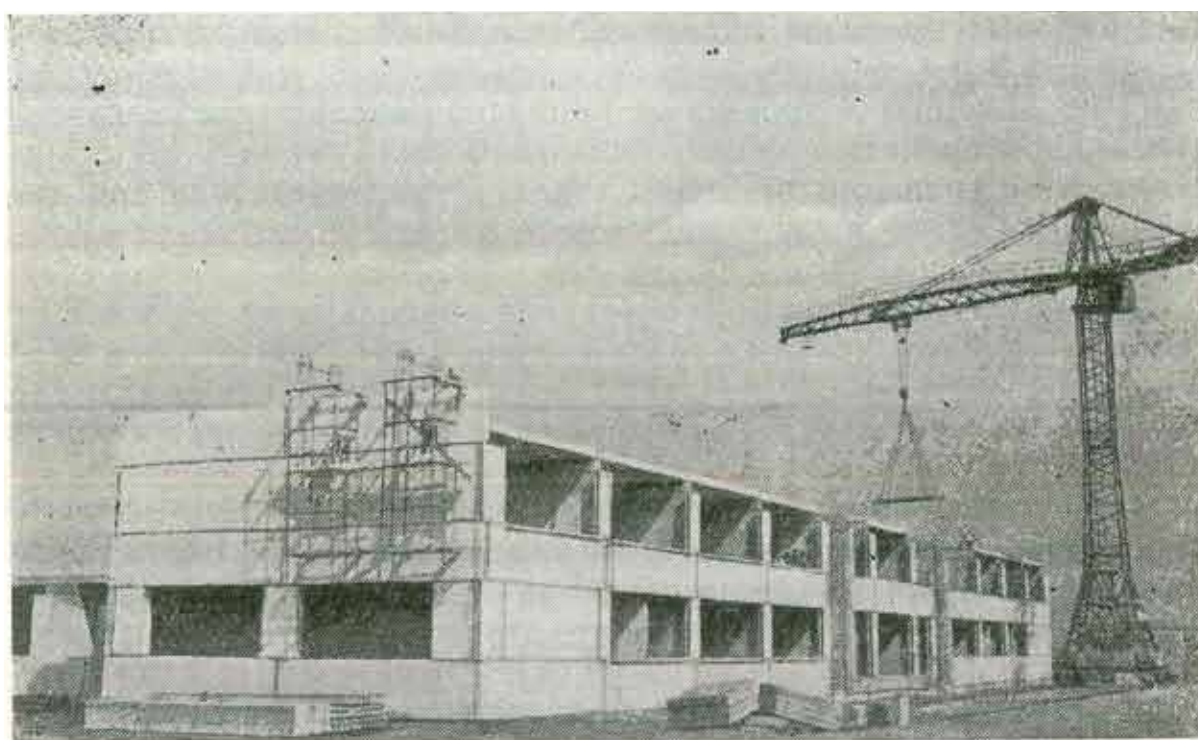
Монтаж конструкций крупнопанельной школы на 640 мест серии I-467 в Подольске
